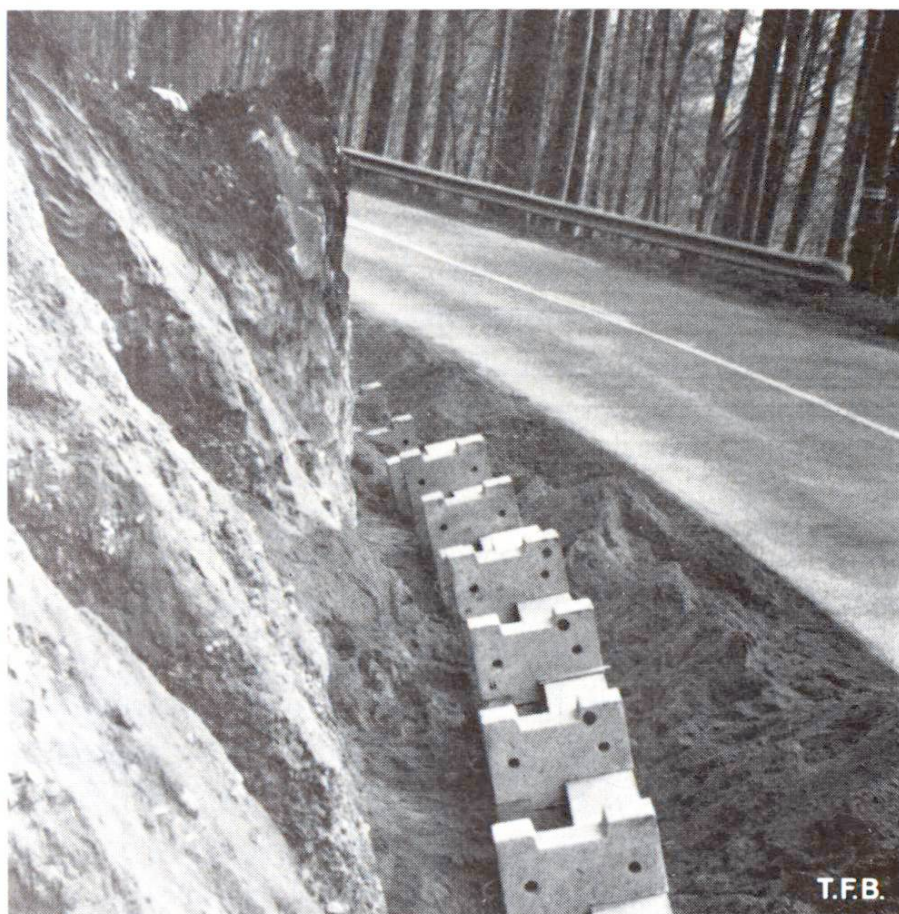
Début du montage d'une construction telle que celles des figures 2 et 3. Sur des plaques de fondation légèrement inclinées viendront s'emboîter des piliers qui à leur tour supporteront les dalles horizontales.
